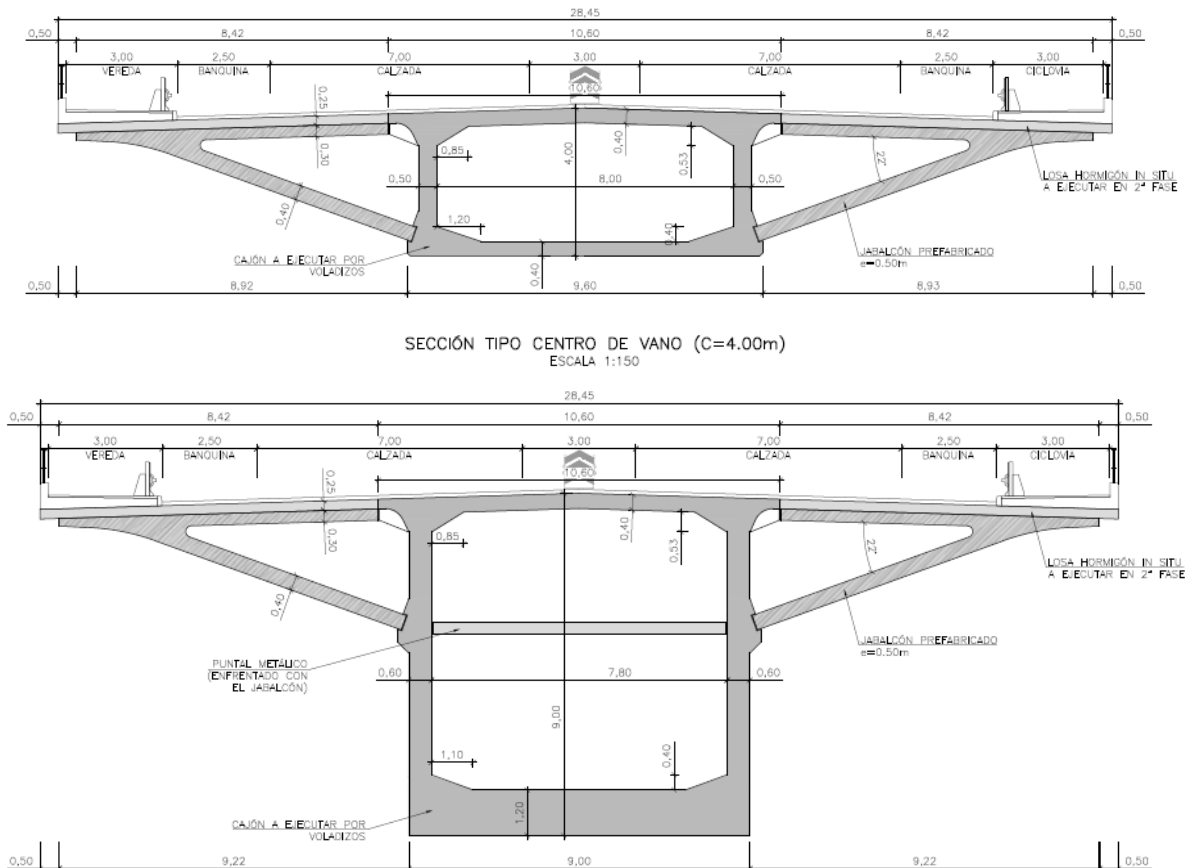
Secciones de tablero en centro de vano y apoyos.
